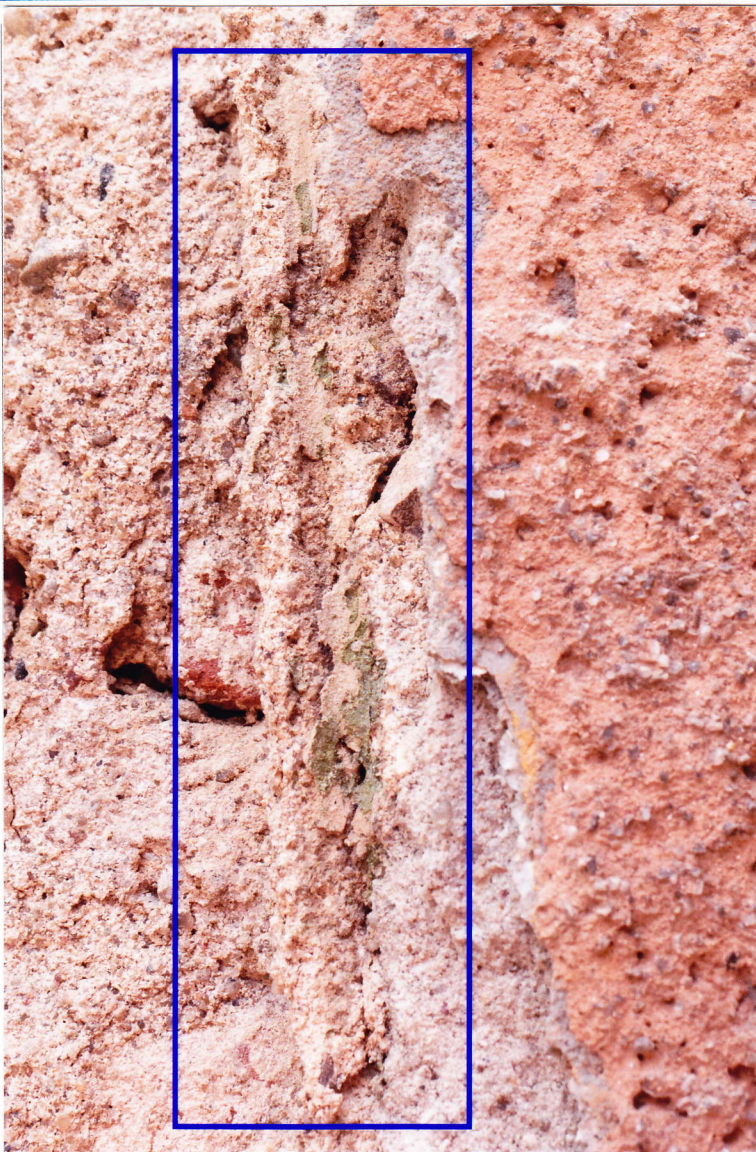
Odkrywka nr 8 – gzyms w elewacji podwórzowej.
